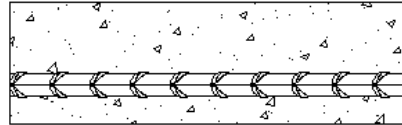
3 Viga de hormigón armado empleando barras corrugadas como refuerzo.
